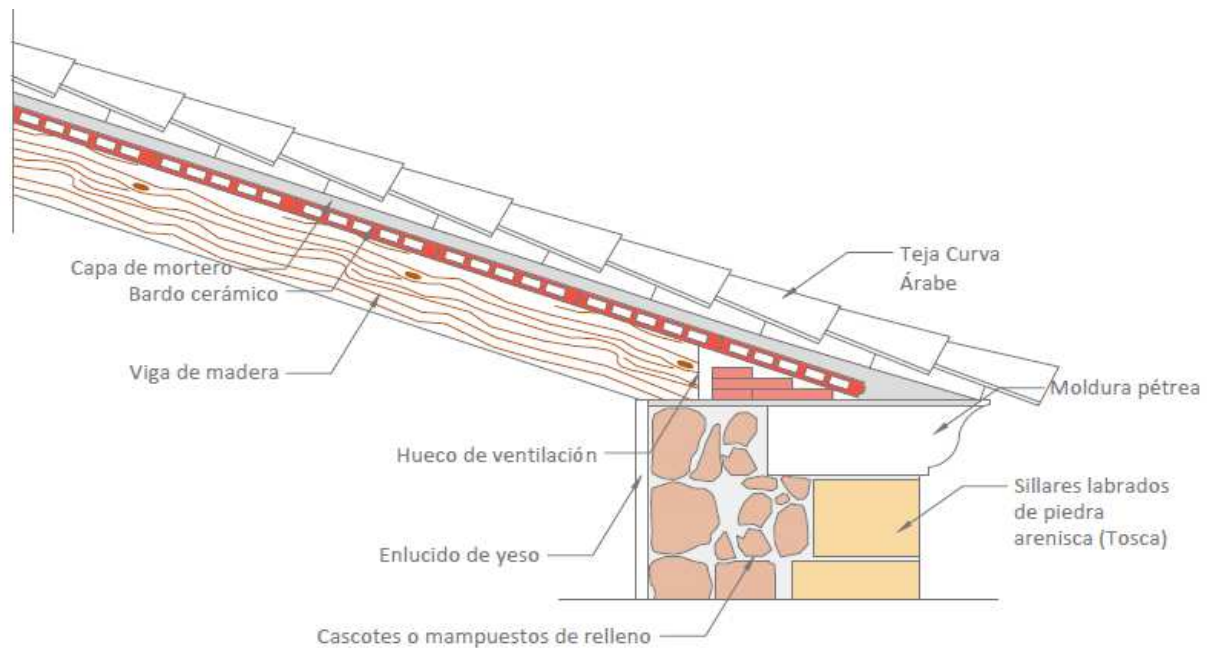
Forjado inclinado bajo cubierta formado por vigas de madera y entrevigado de bardos cerámicos. Elaboración propia
